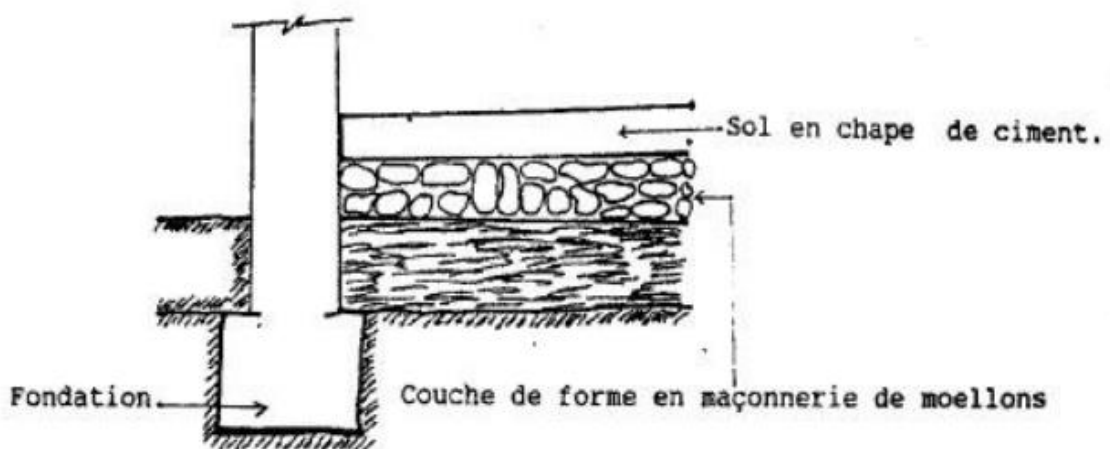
Détail constructif d'un pavement en matériaux locaux
